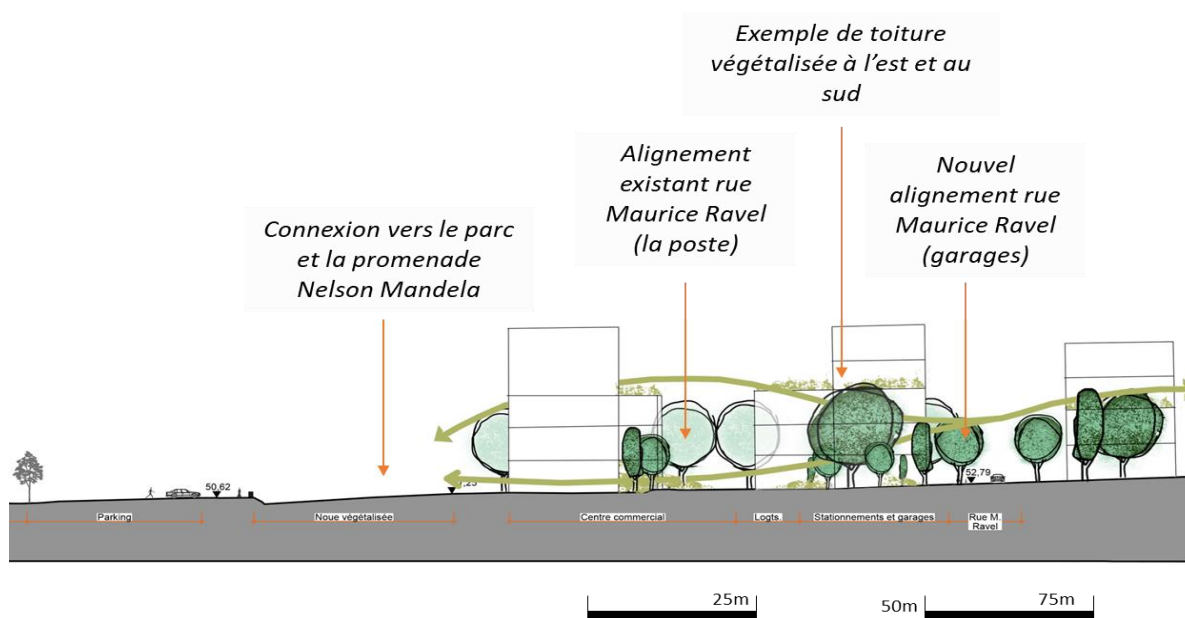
Ilots futurs : coupe du projet (source : Ouest Am')
